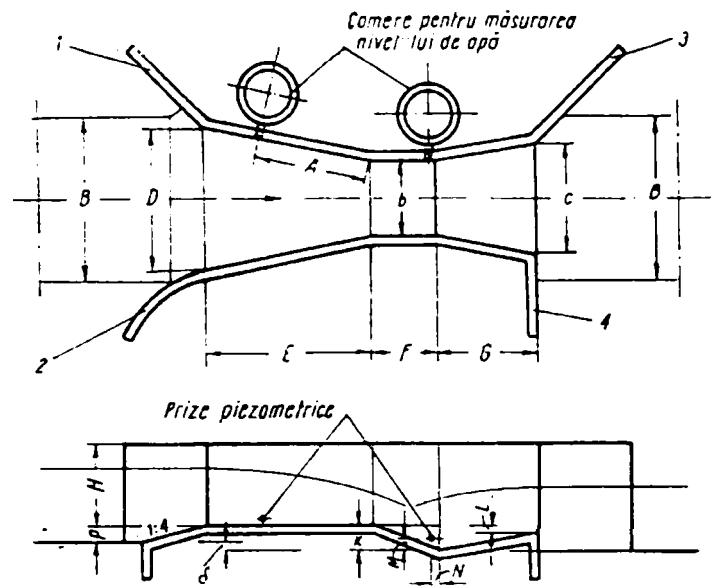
„Vederea în plan și secțiunea longitudinală a canalului de măsură de tip Parshall”
